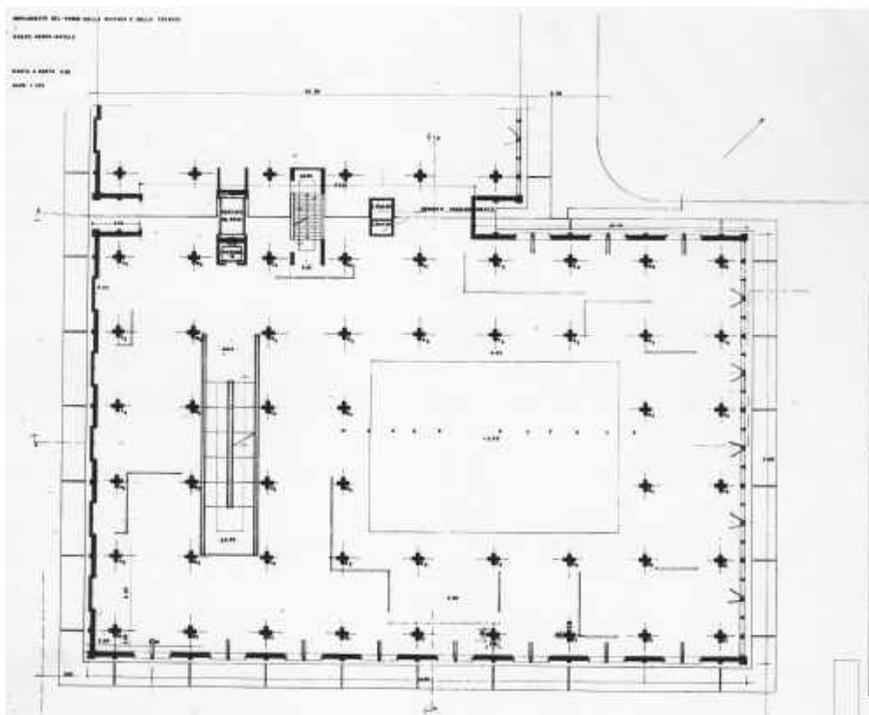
Padiglione Aeronavale, pianta piano terra, seconda soluzione
